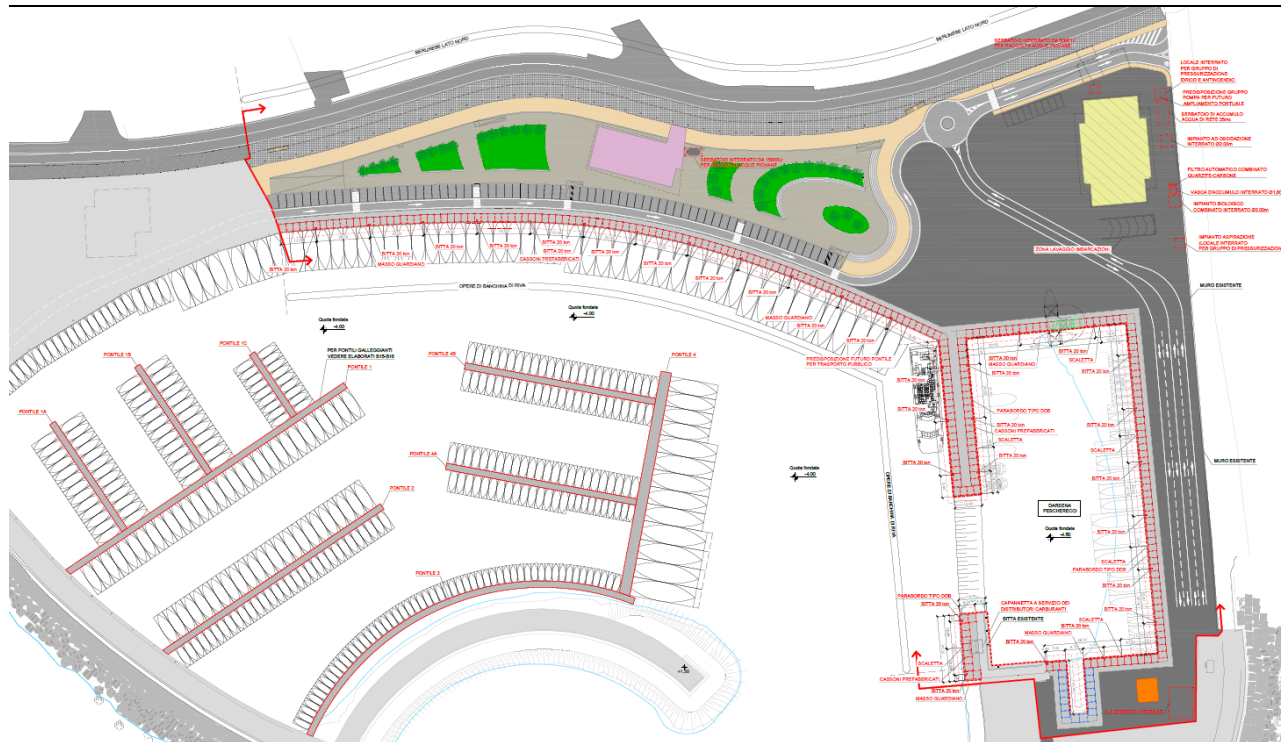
Estratto dalla tavola B12 - Planimetria con identificazione degli interventi
